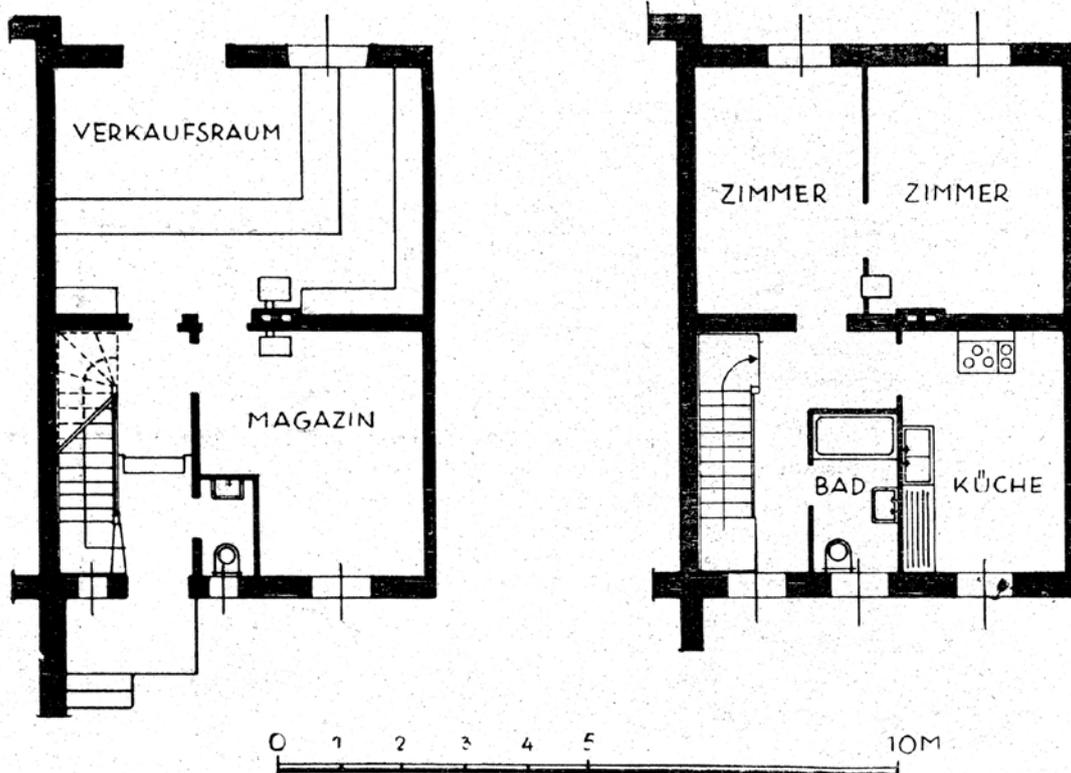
Erdgeschoß und I. Stock eines Kleinhauses. Bauherr war ein kleiner Kaufmann. Entwurf Arch. Eugen Wachberger
